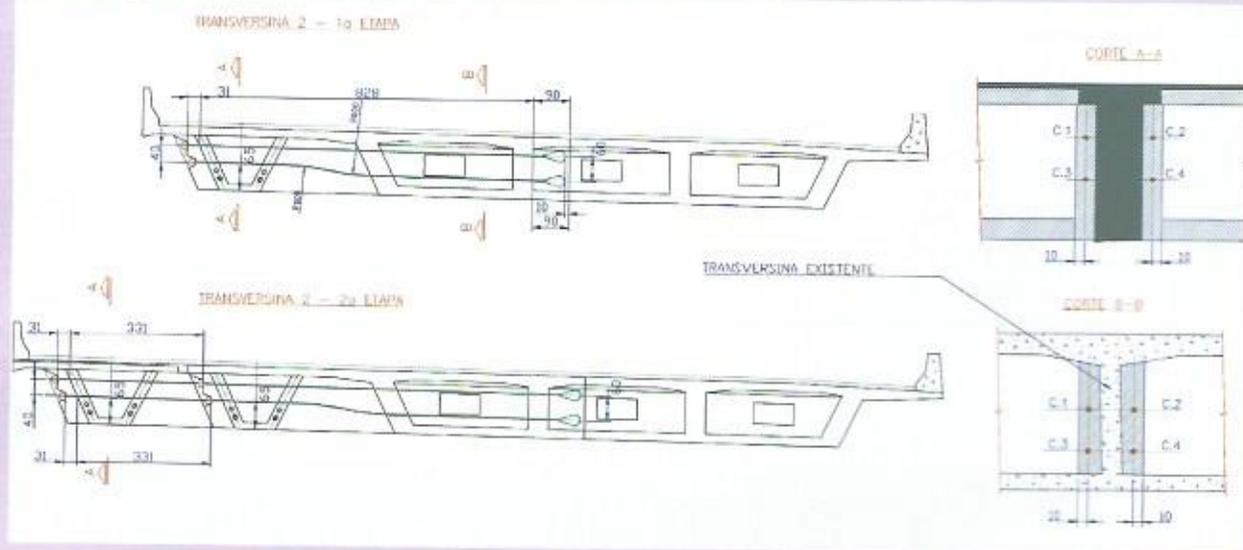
PI no km 27: Protensão transversal (ambas as fases).
